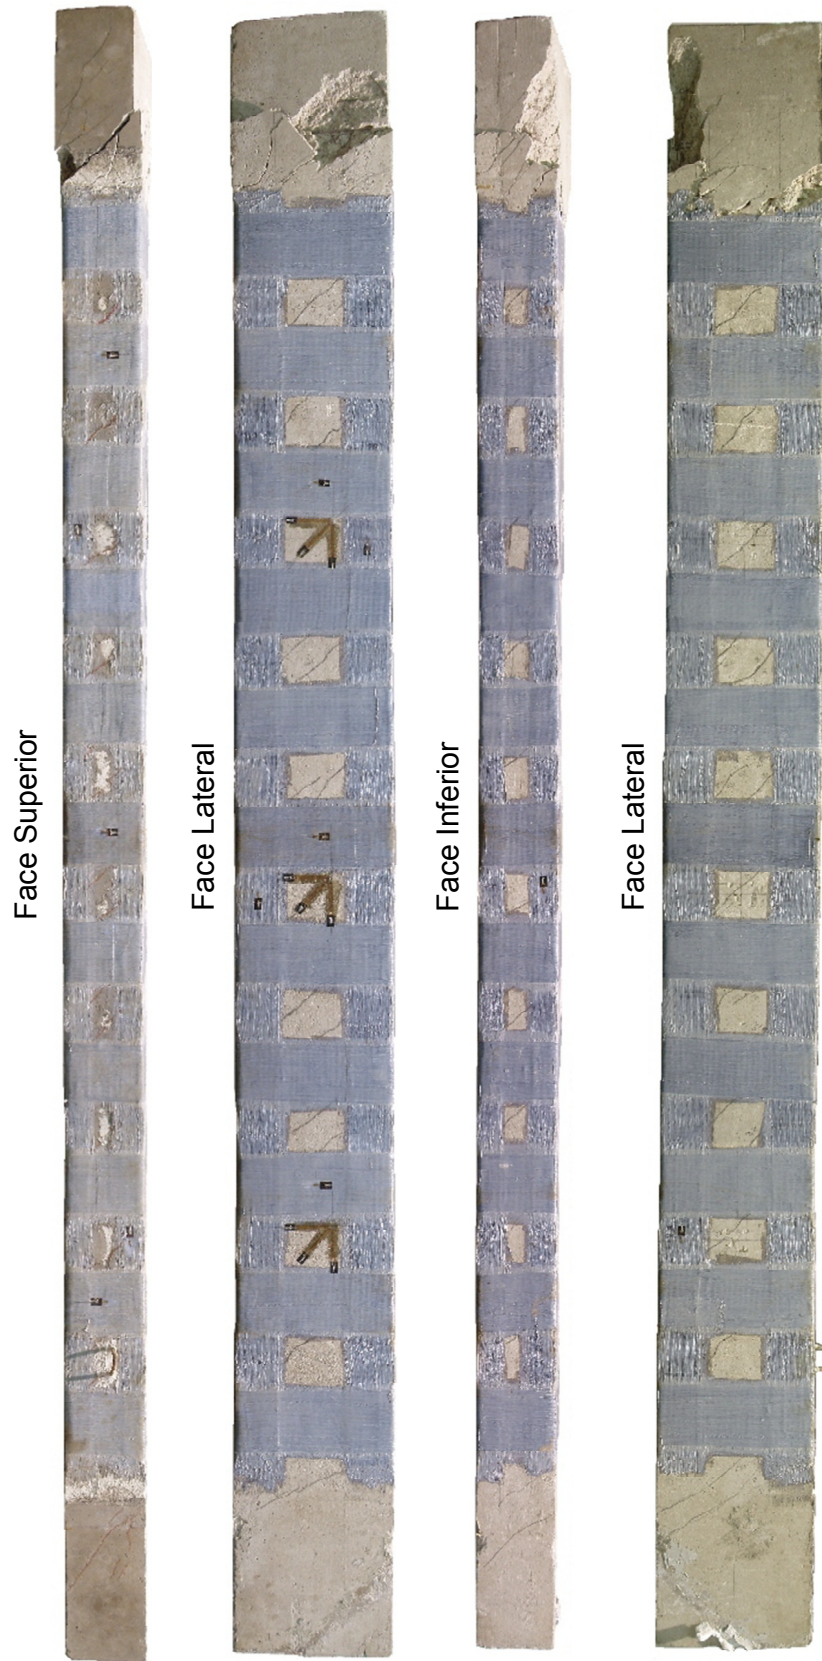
Configuração das fissuras da viga VTL1.
